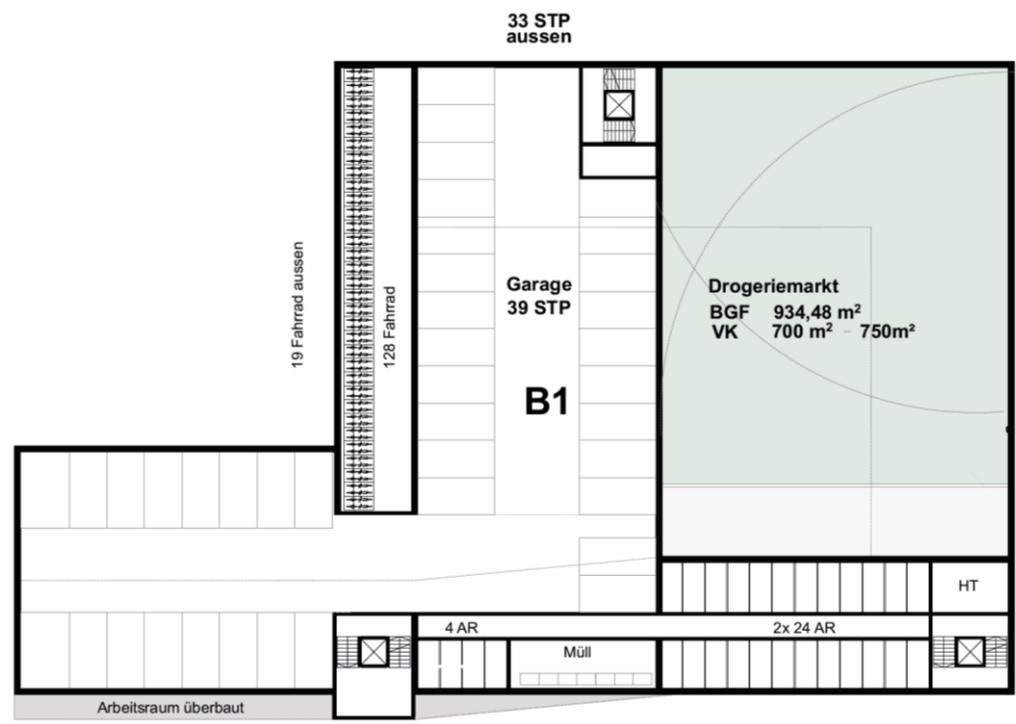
Grundriss unterstes Geschoss mit Drogeriemarkt und Gemeinschaftstiefgarage der Gebäude B1a und B1b
